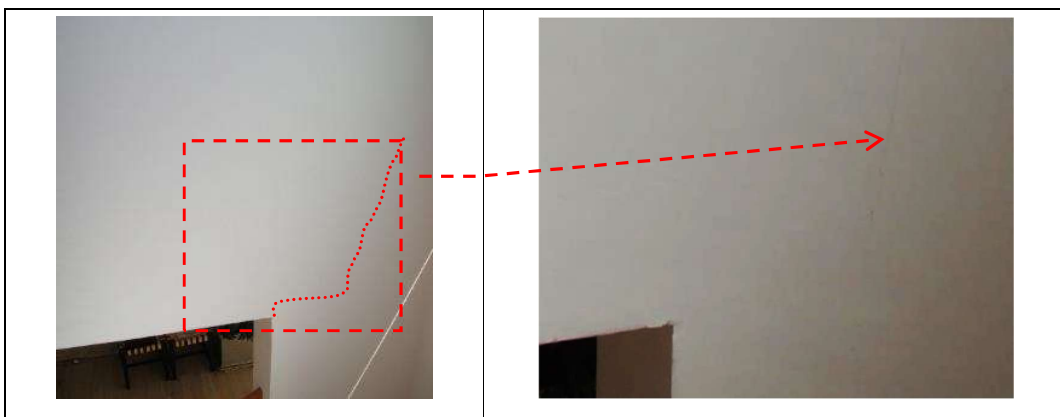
Agrietamiento en muro de caja de escalera
